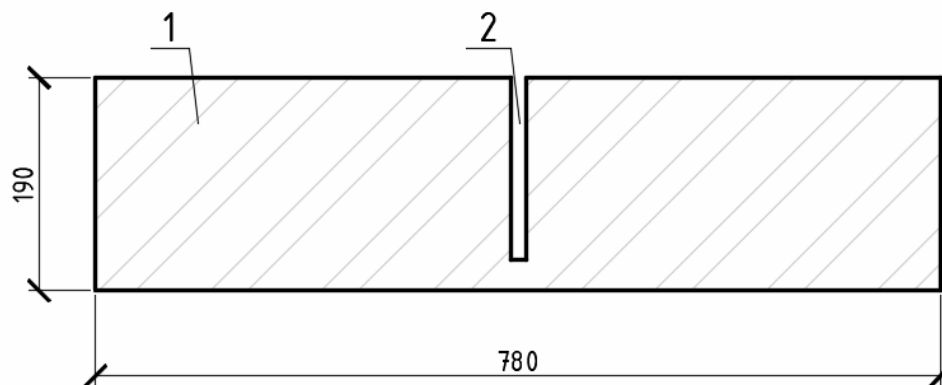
Схема сечения стены по кладке без утеплителя с дефектом
